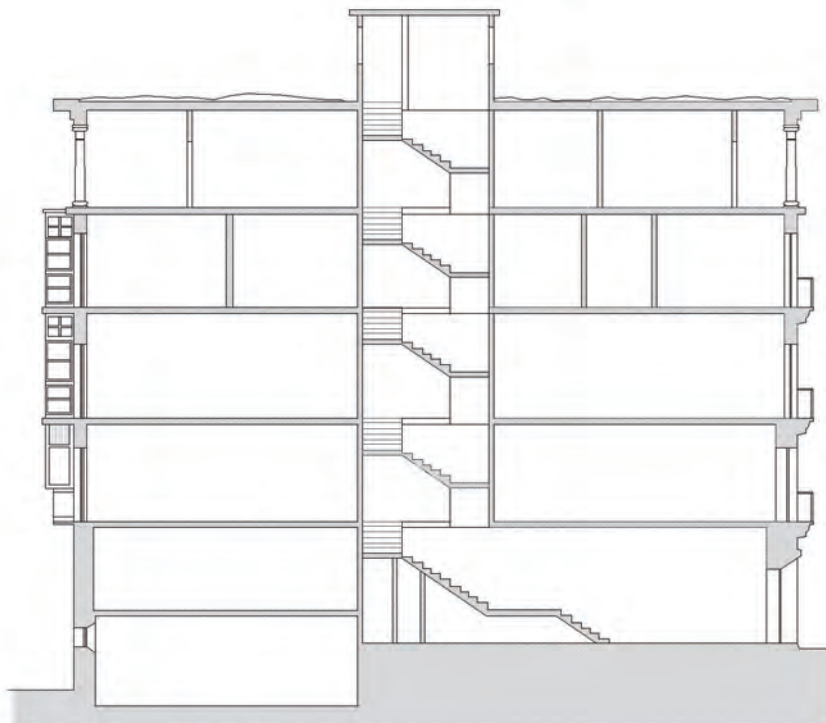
14. SECCIÓN POR CAJA DE ESCALERAS
